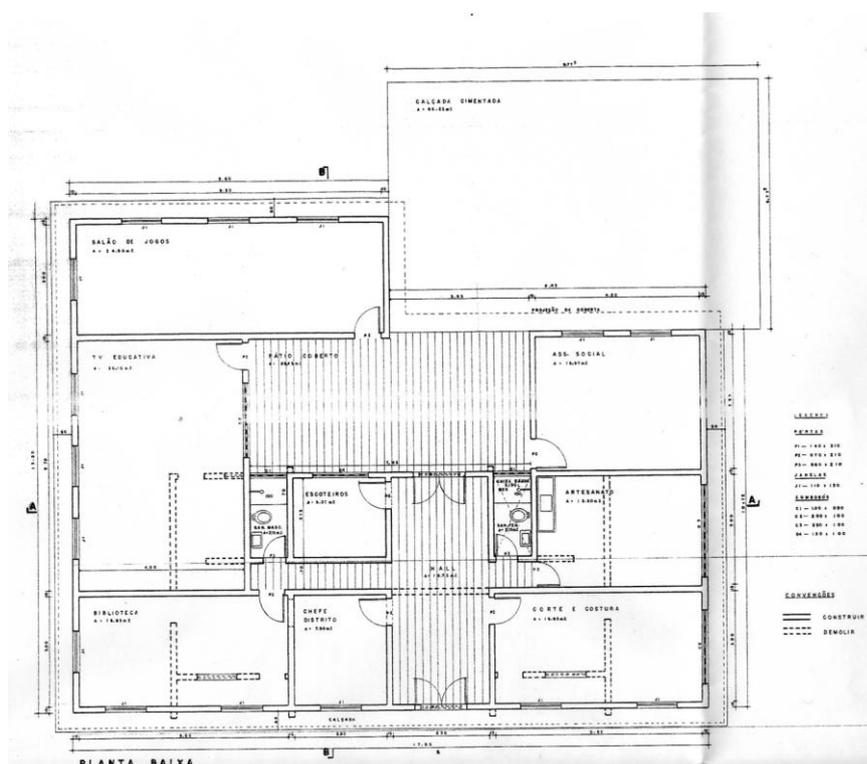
Planta baixa do Centrinho (Fonte: Cohab)
